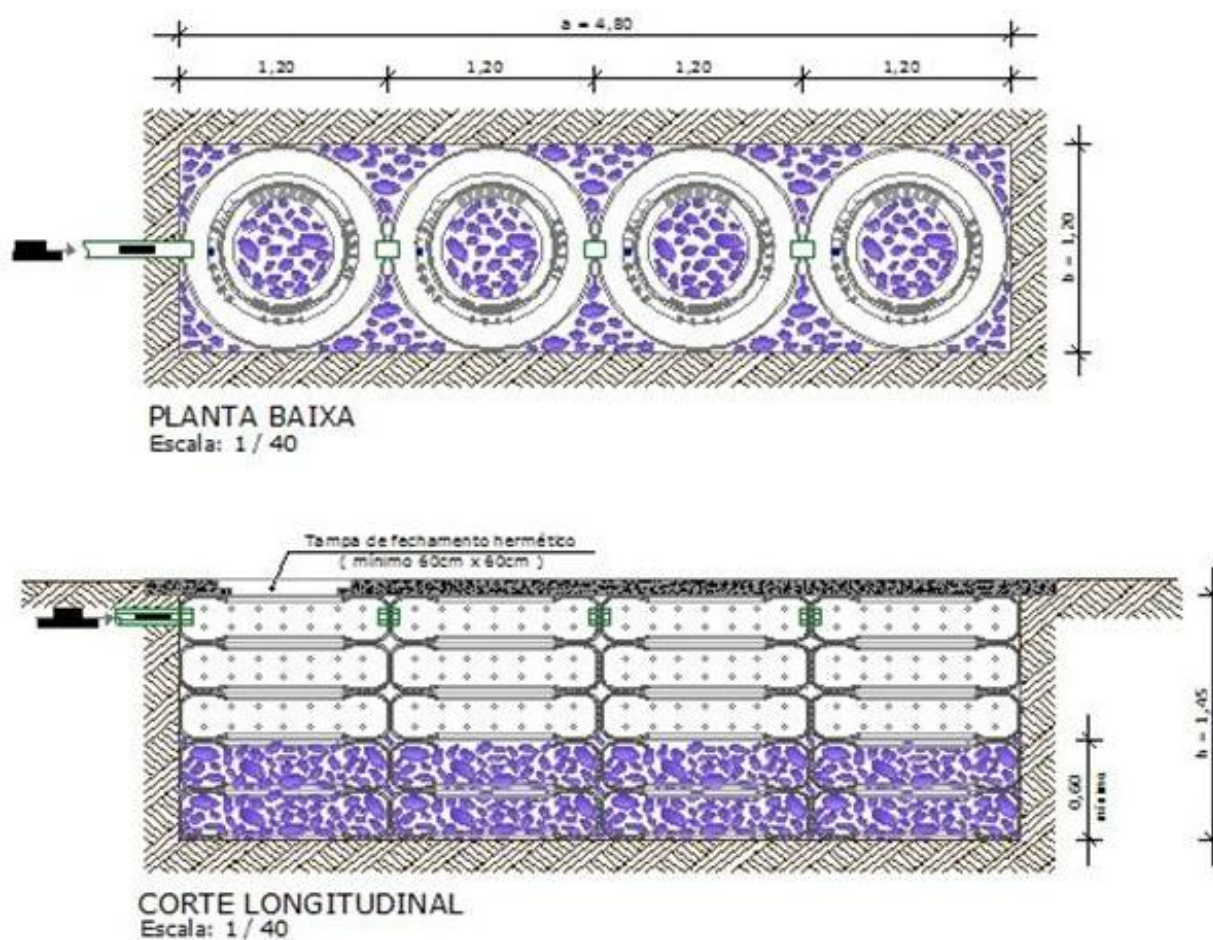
Planta baixa e corte do sumidouro de pneus
